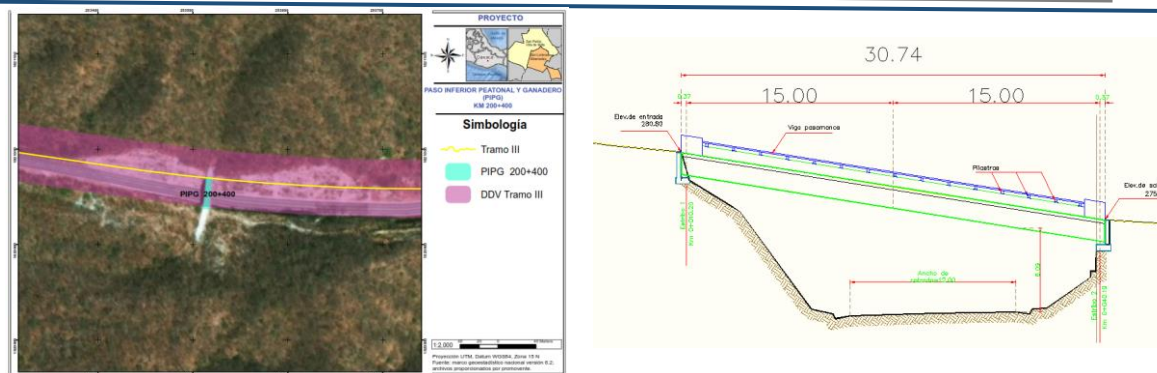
Proyecto en planta y corte longitudinal del PIPG 200+400
